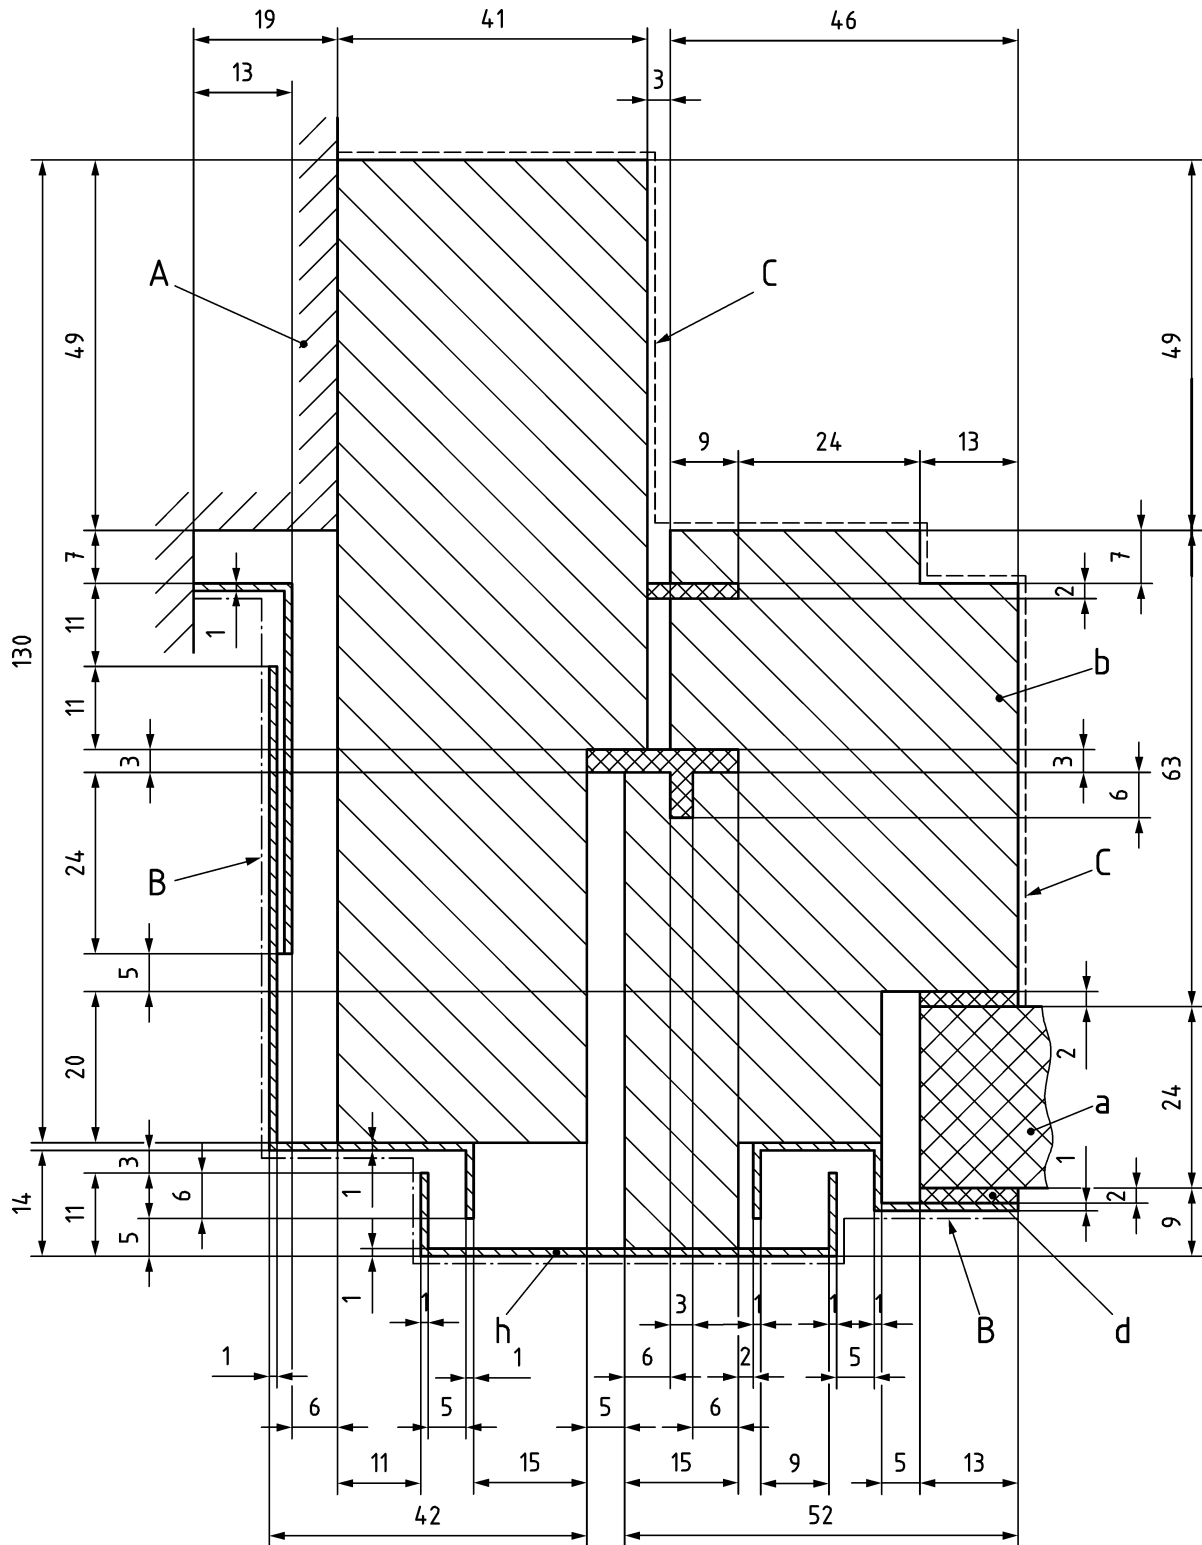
Seção de perfil de PVC com reforço de aço e painel de isolante térmico
